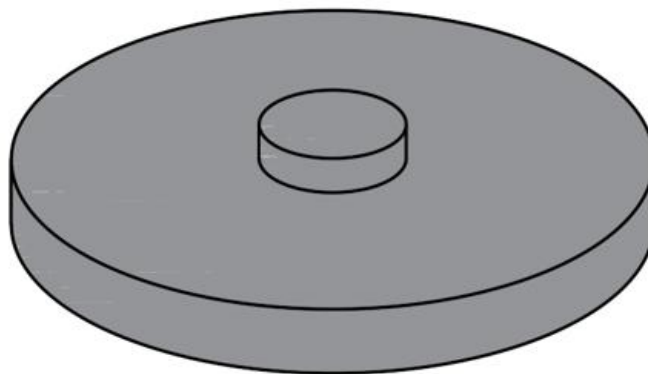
Croquis de la alternativa 1: zapata cilíndrica. Fuente: Elaboración propia.
